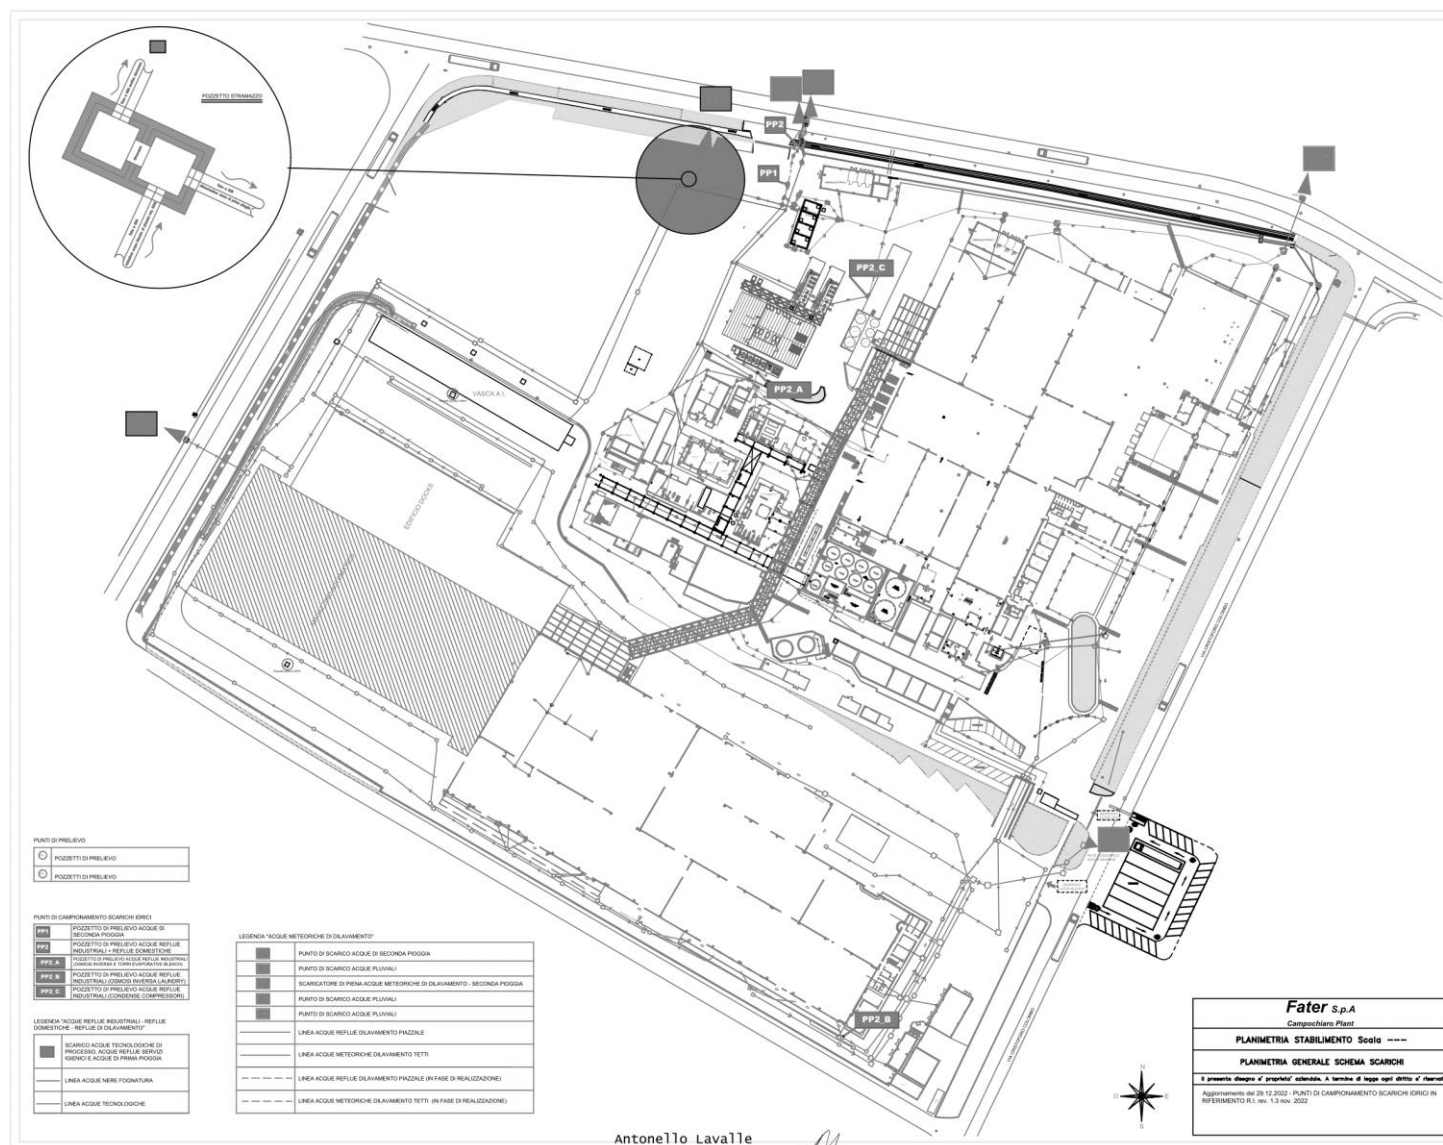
planimetria generale di stabilimento con indicazione dei punti di emissione idrica: assetto autorizzato con D.D. della Regione MOLISE n. 1869 del 31/03/2026
